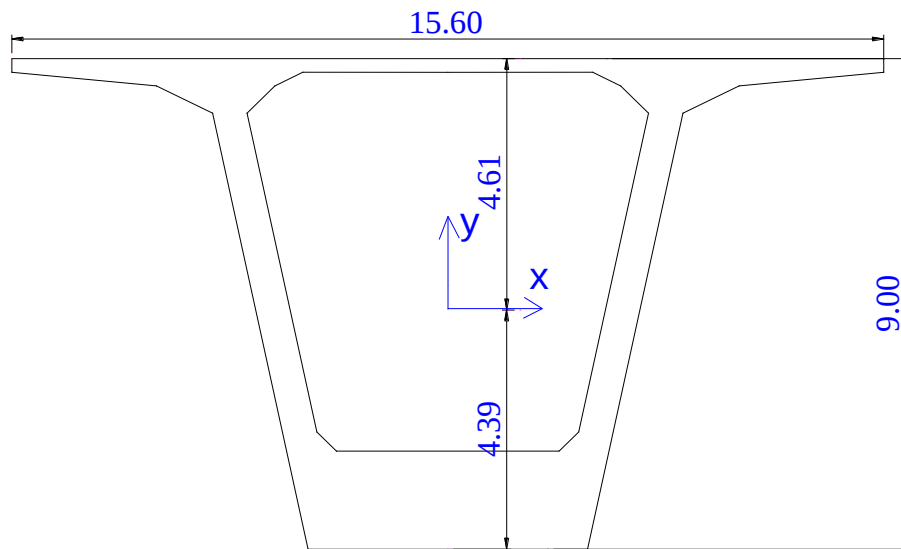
Voussoir sur pile (Caractéristiques mécaniques).
